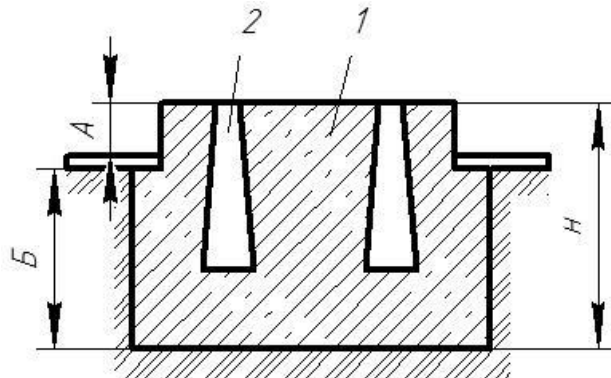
Фундамент під обладнання: 1 – бетон фундаменту; 2 – колодці
